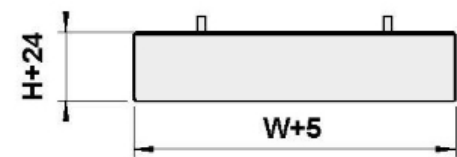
Halton Rex REP, dimensions de la vue de côté
